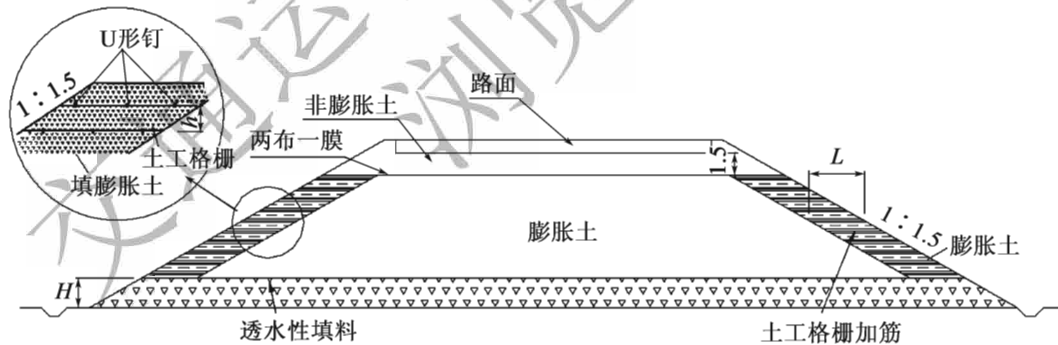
土工格栅加筋膨胀土路堤横断面图(尺寸单位:m)
